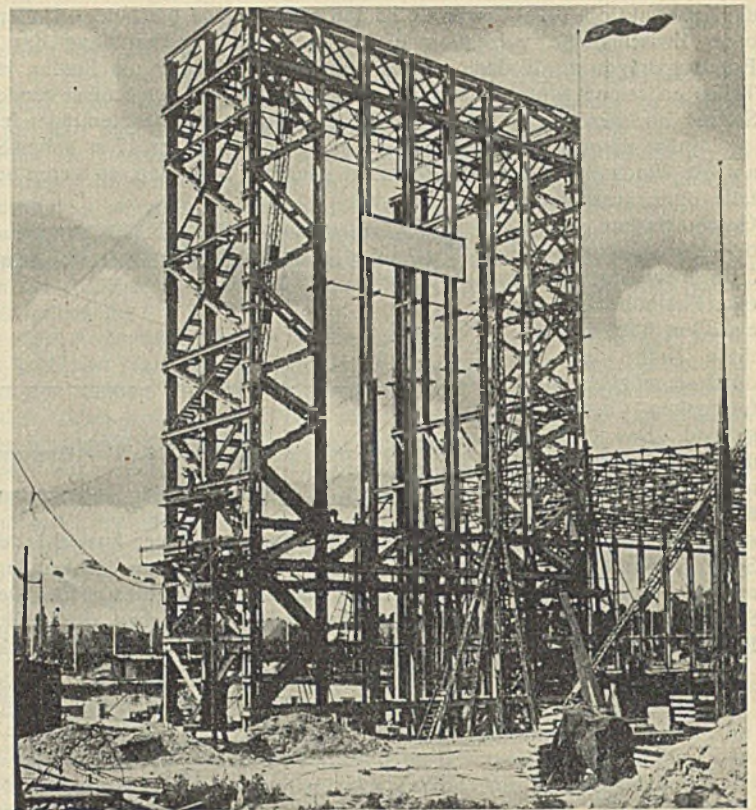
Frontwandrahmen und Dachbinder der Ehrenhalle mit Zwischenstützen.
